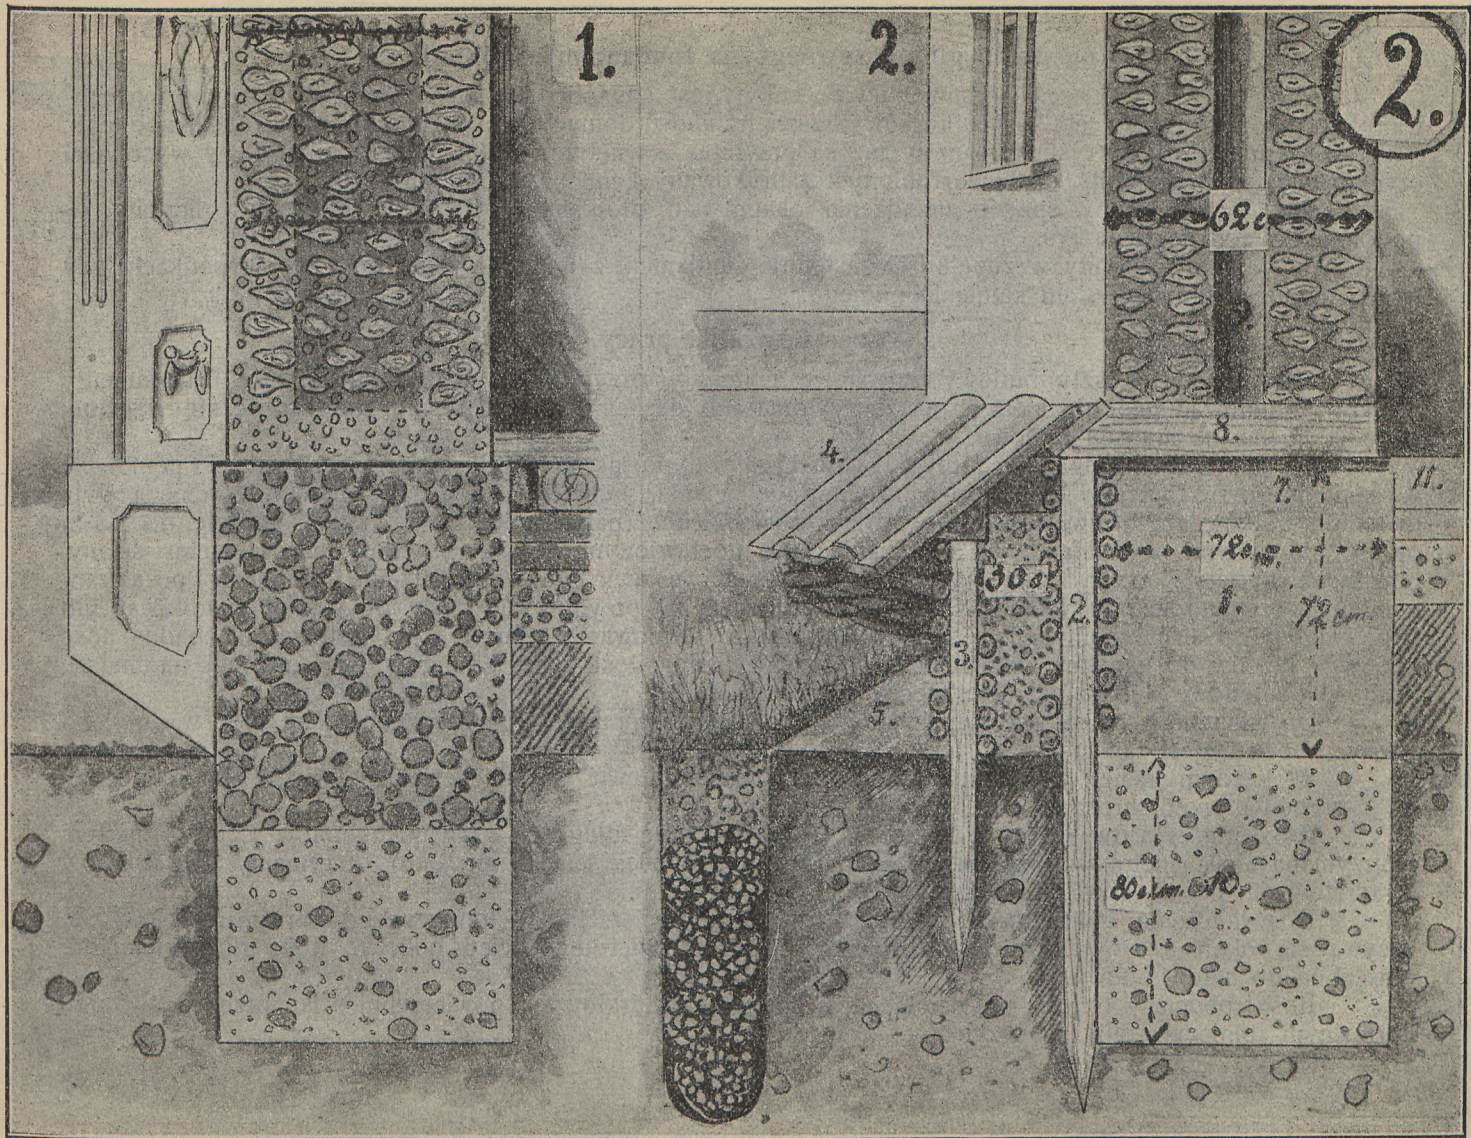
Przekrój poprzeczny drzewobetonowego muru na betonowym fundamencie.
